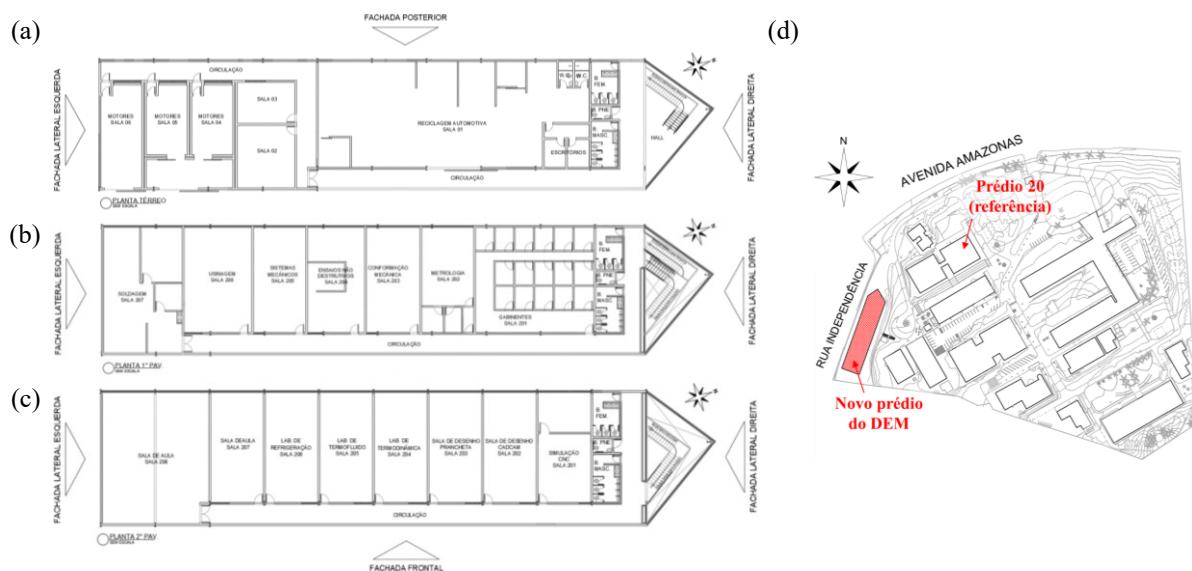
Plantas do prédio a ser construído no Campus NG: (a) pavimento térreo, (b) 1º pavimento; (c) 2º pavimento; e (d) implantação. Fonte: Adaptado de Divisão de Projetos do CEFET-MG.
